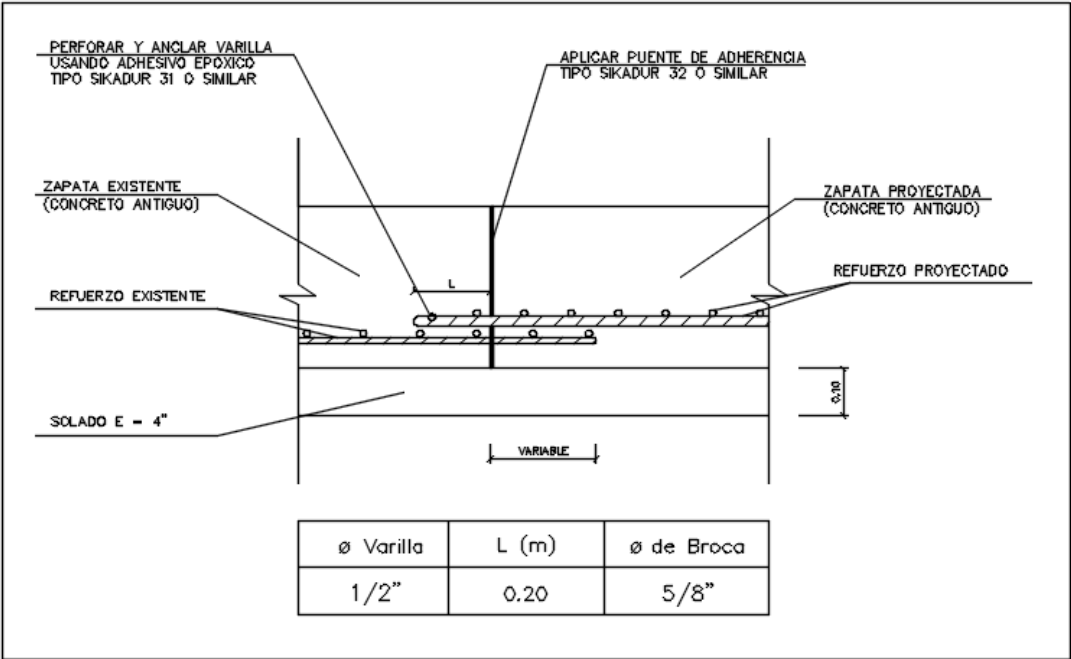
Detalle típico de encuentro de zapata existente con zapata proyectada
